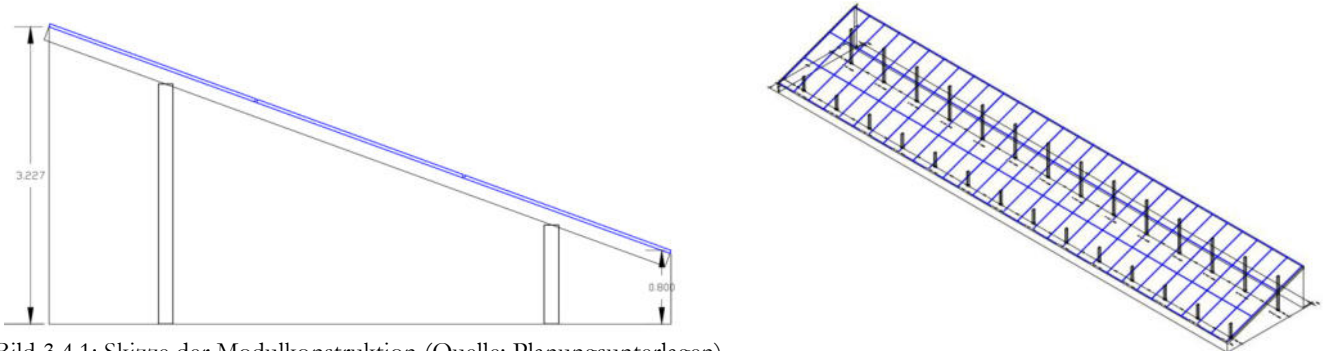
Skizze der Modulkonstruktion (Quelle: Planungsunterlagen)
